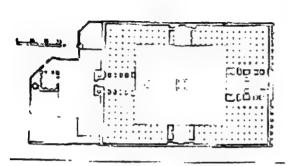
حيس، الجامع الكبير، المسقط الأفقي كما وضعته بريارا فنستر
